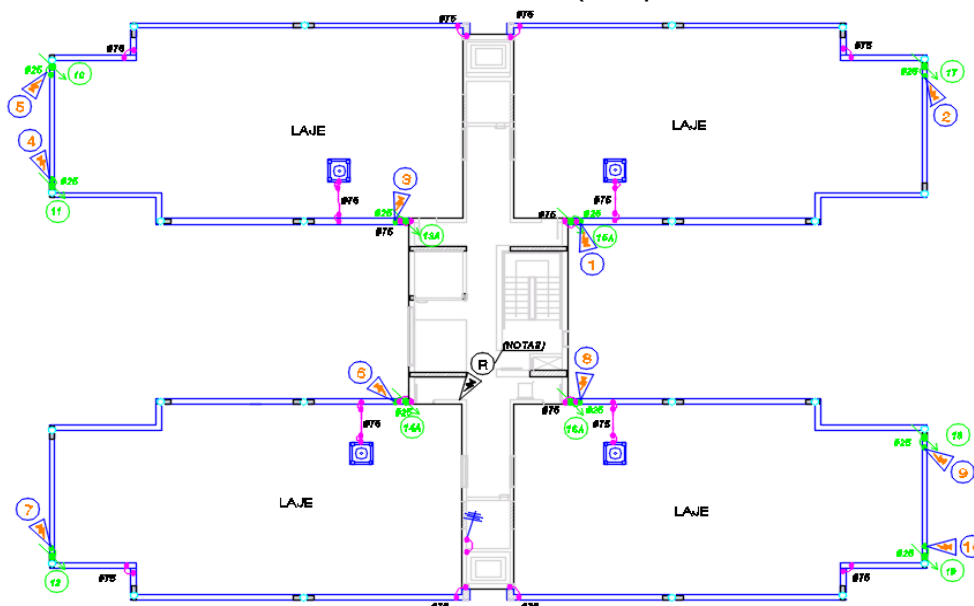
Croqui da Planta do sistema de captadores com os Pontos de Medição de Continuidade elétrica realizadas na cobertura – (Ver planta SPD-009-03 - Torre 02).
